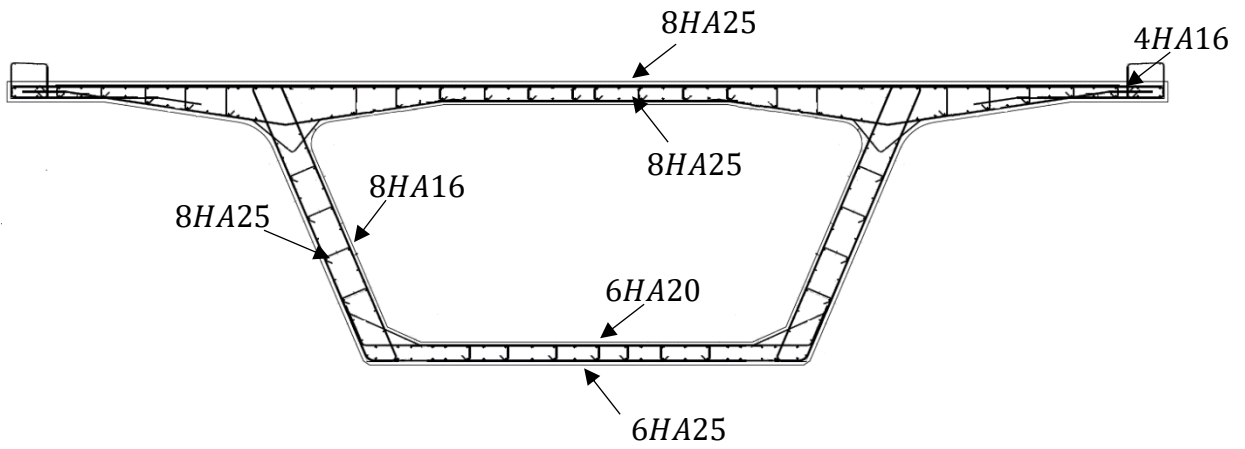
Schémat de ferraillage du voussoir sur culée.
